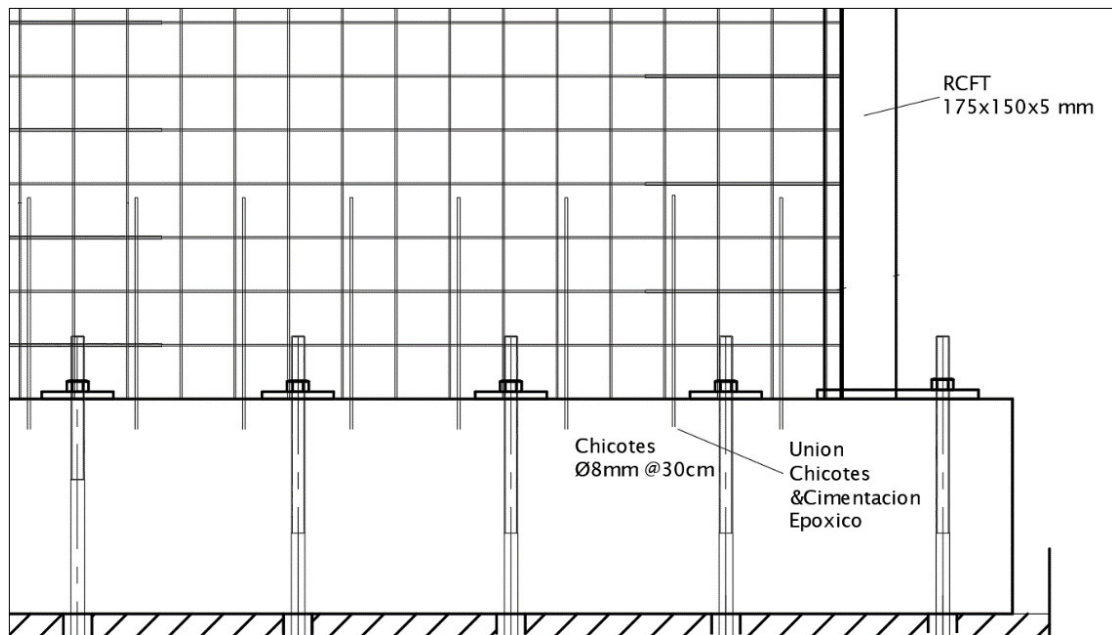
Detalle conexión inferior malla electrosoldada-viga cimentación.
